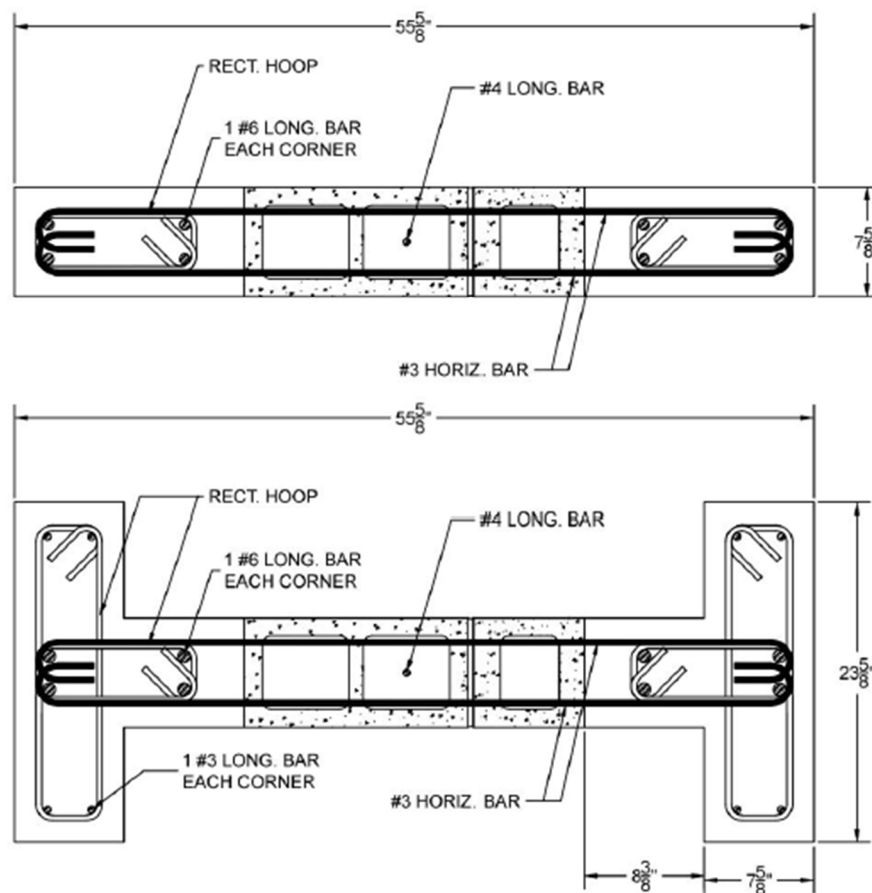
Configuración de columnas de mampostería estructural como elemento de borde
